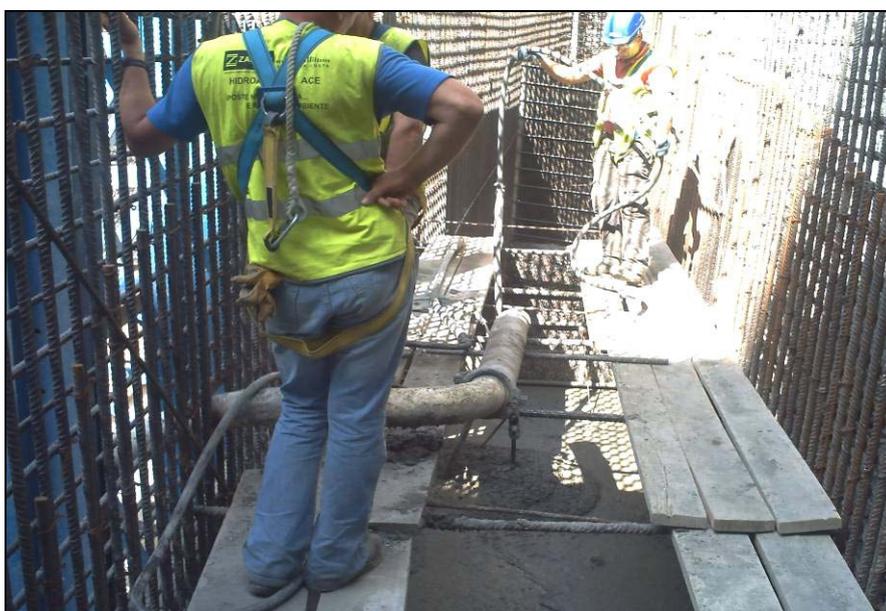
Tomada de Água. Betonagem de um trecho da parede Sul
